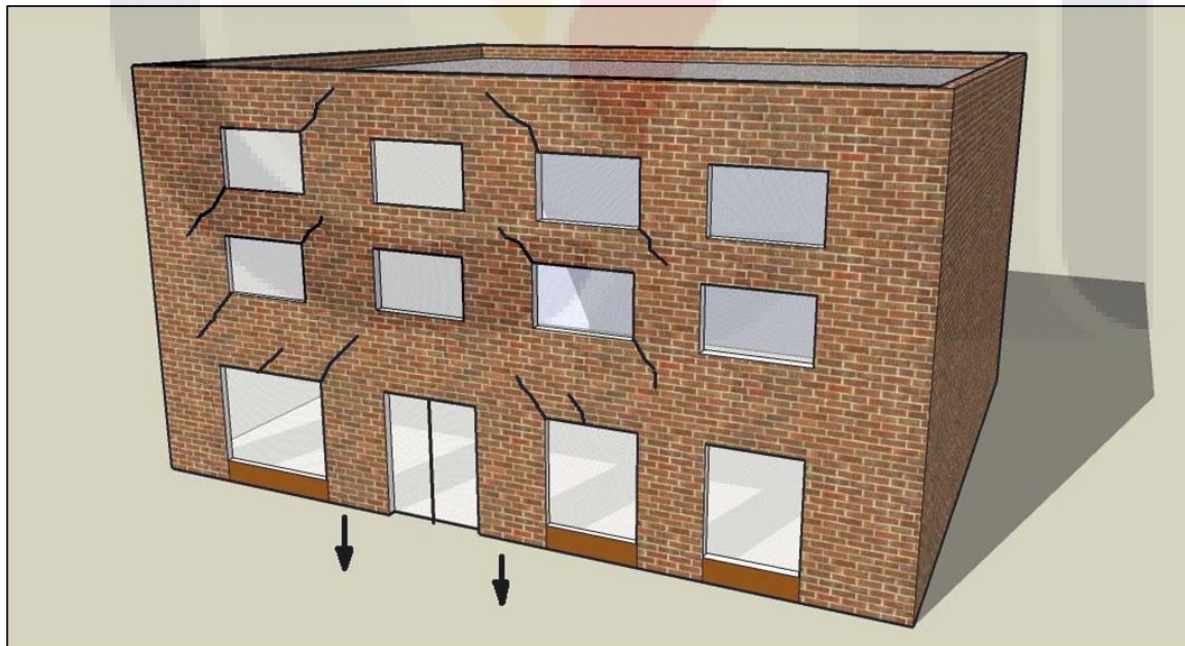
Fisuras provocadas por asentamiento diferencial al centro del edificio de mampostería. Adaptado de Genescà et al., 1997.
